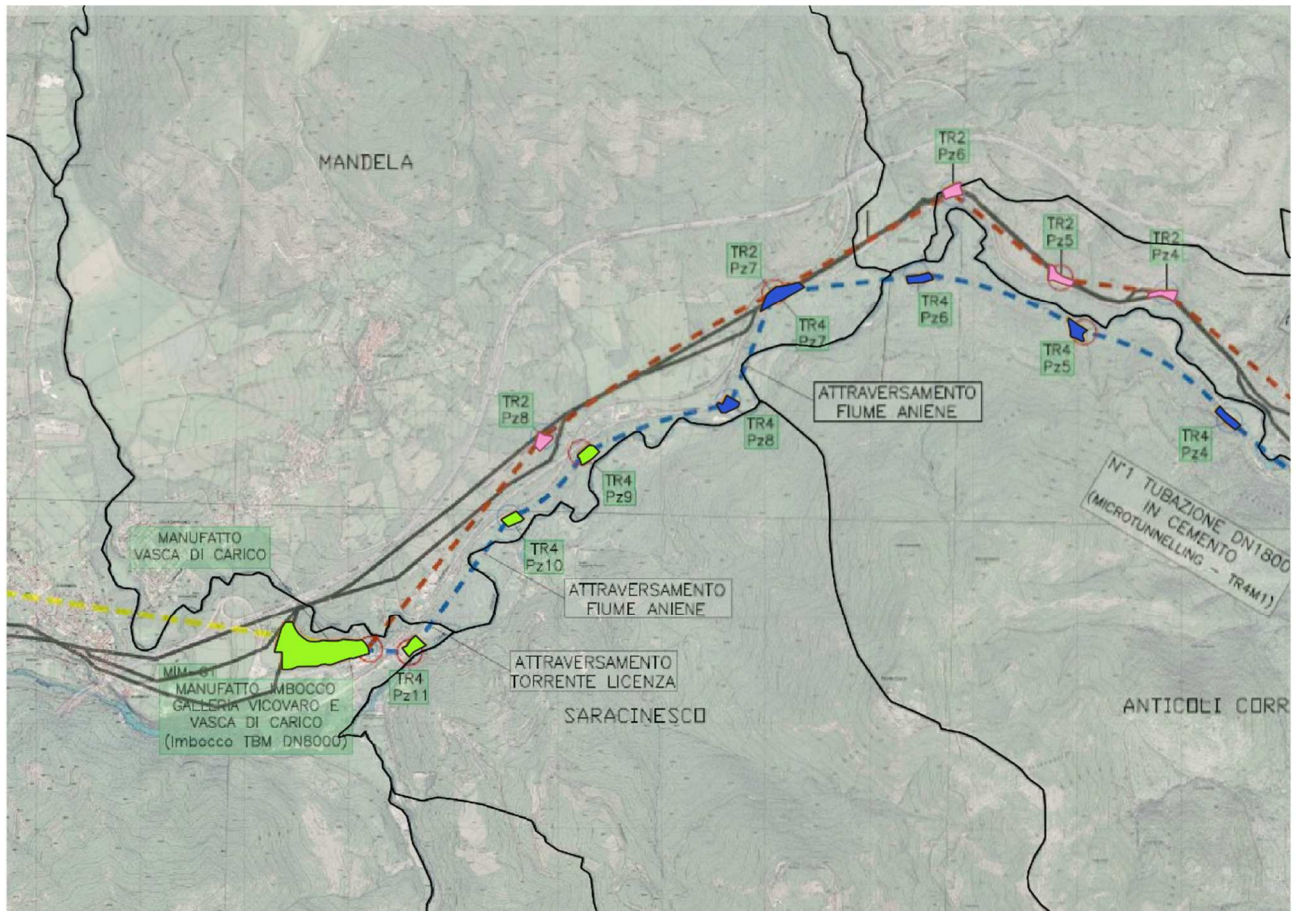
Localizzazione aree di cantiere dal pozzo Tr4Pz6 al Tr4Pz8
